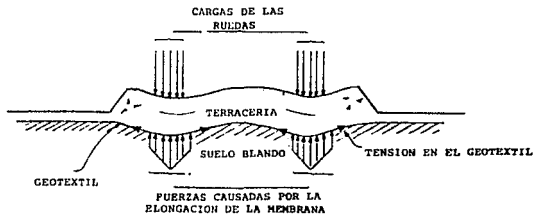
MECANISMO DEL EFECTO ESTRUCTURAL DE LOS GEOTEXTILES EN LA CONSERVACION DE LA CARRETERA.
